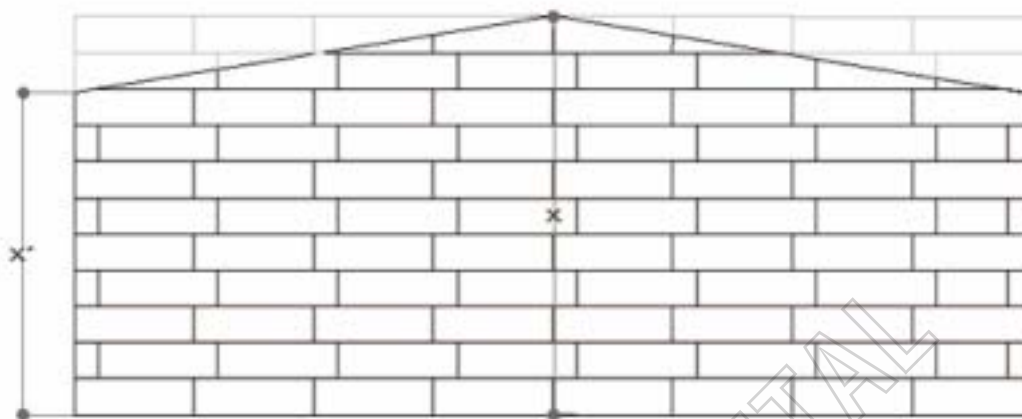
Esquema de muro de apoyo de cubierta inclinada
